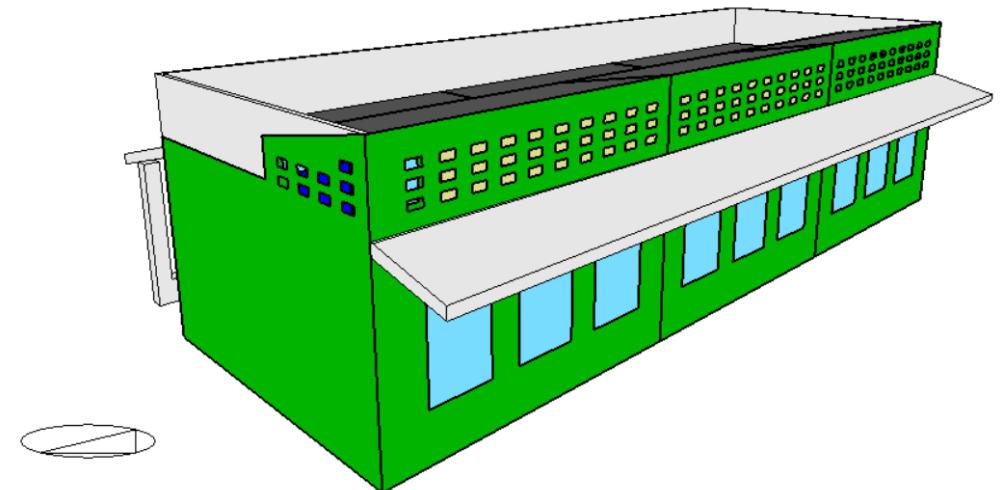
Modelo Tridimensional del Módulo de Aulas – Vista Noreste
